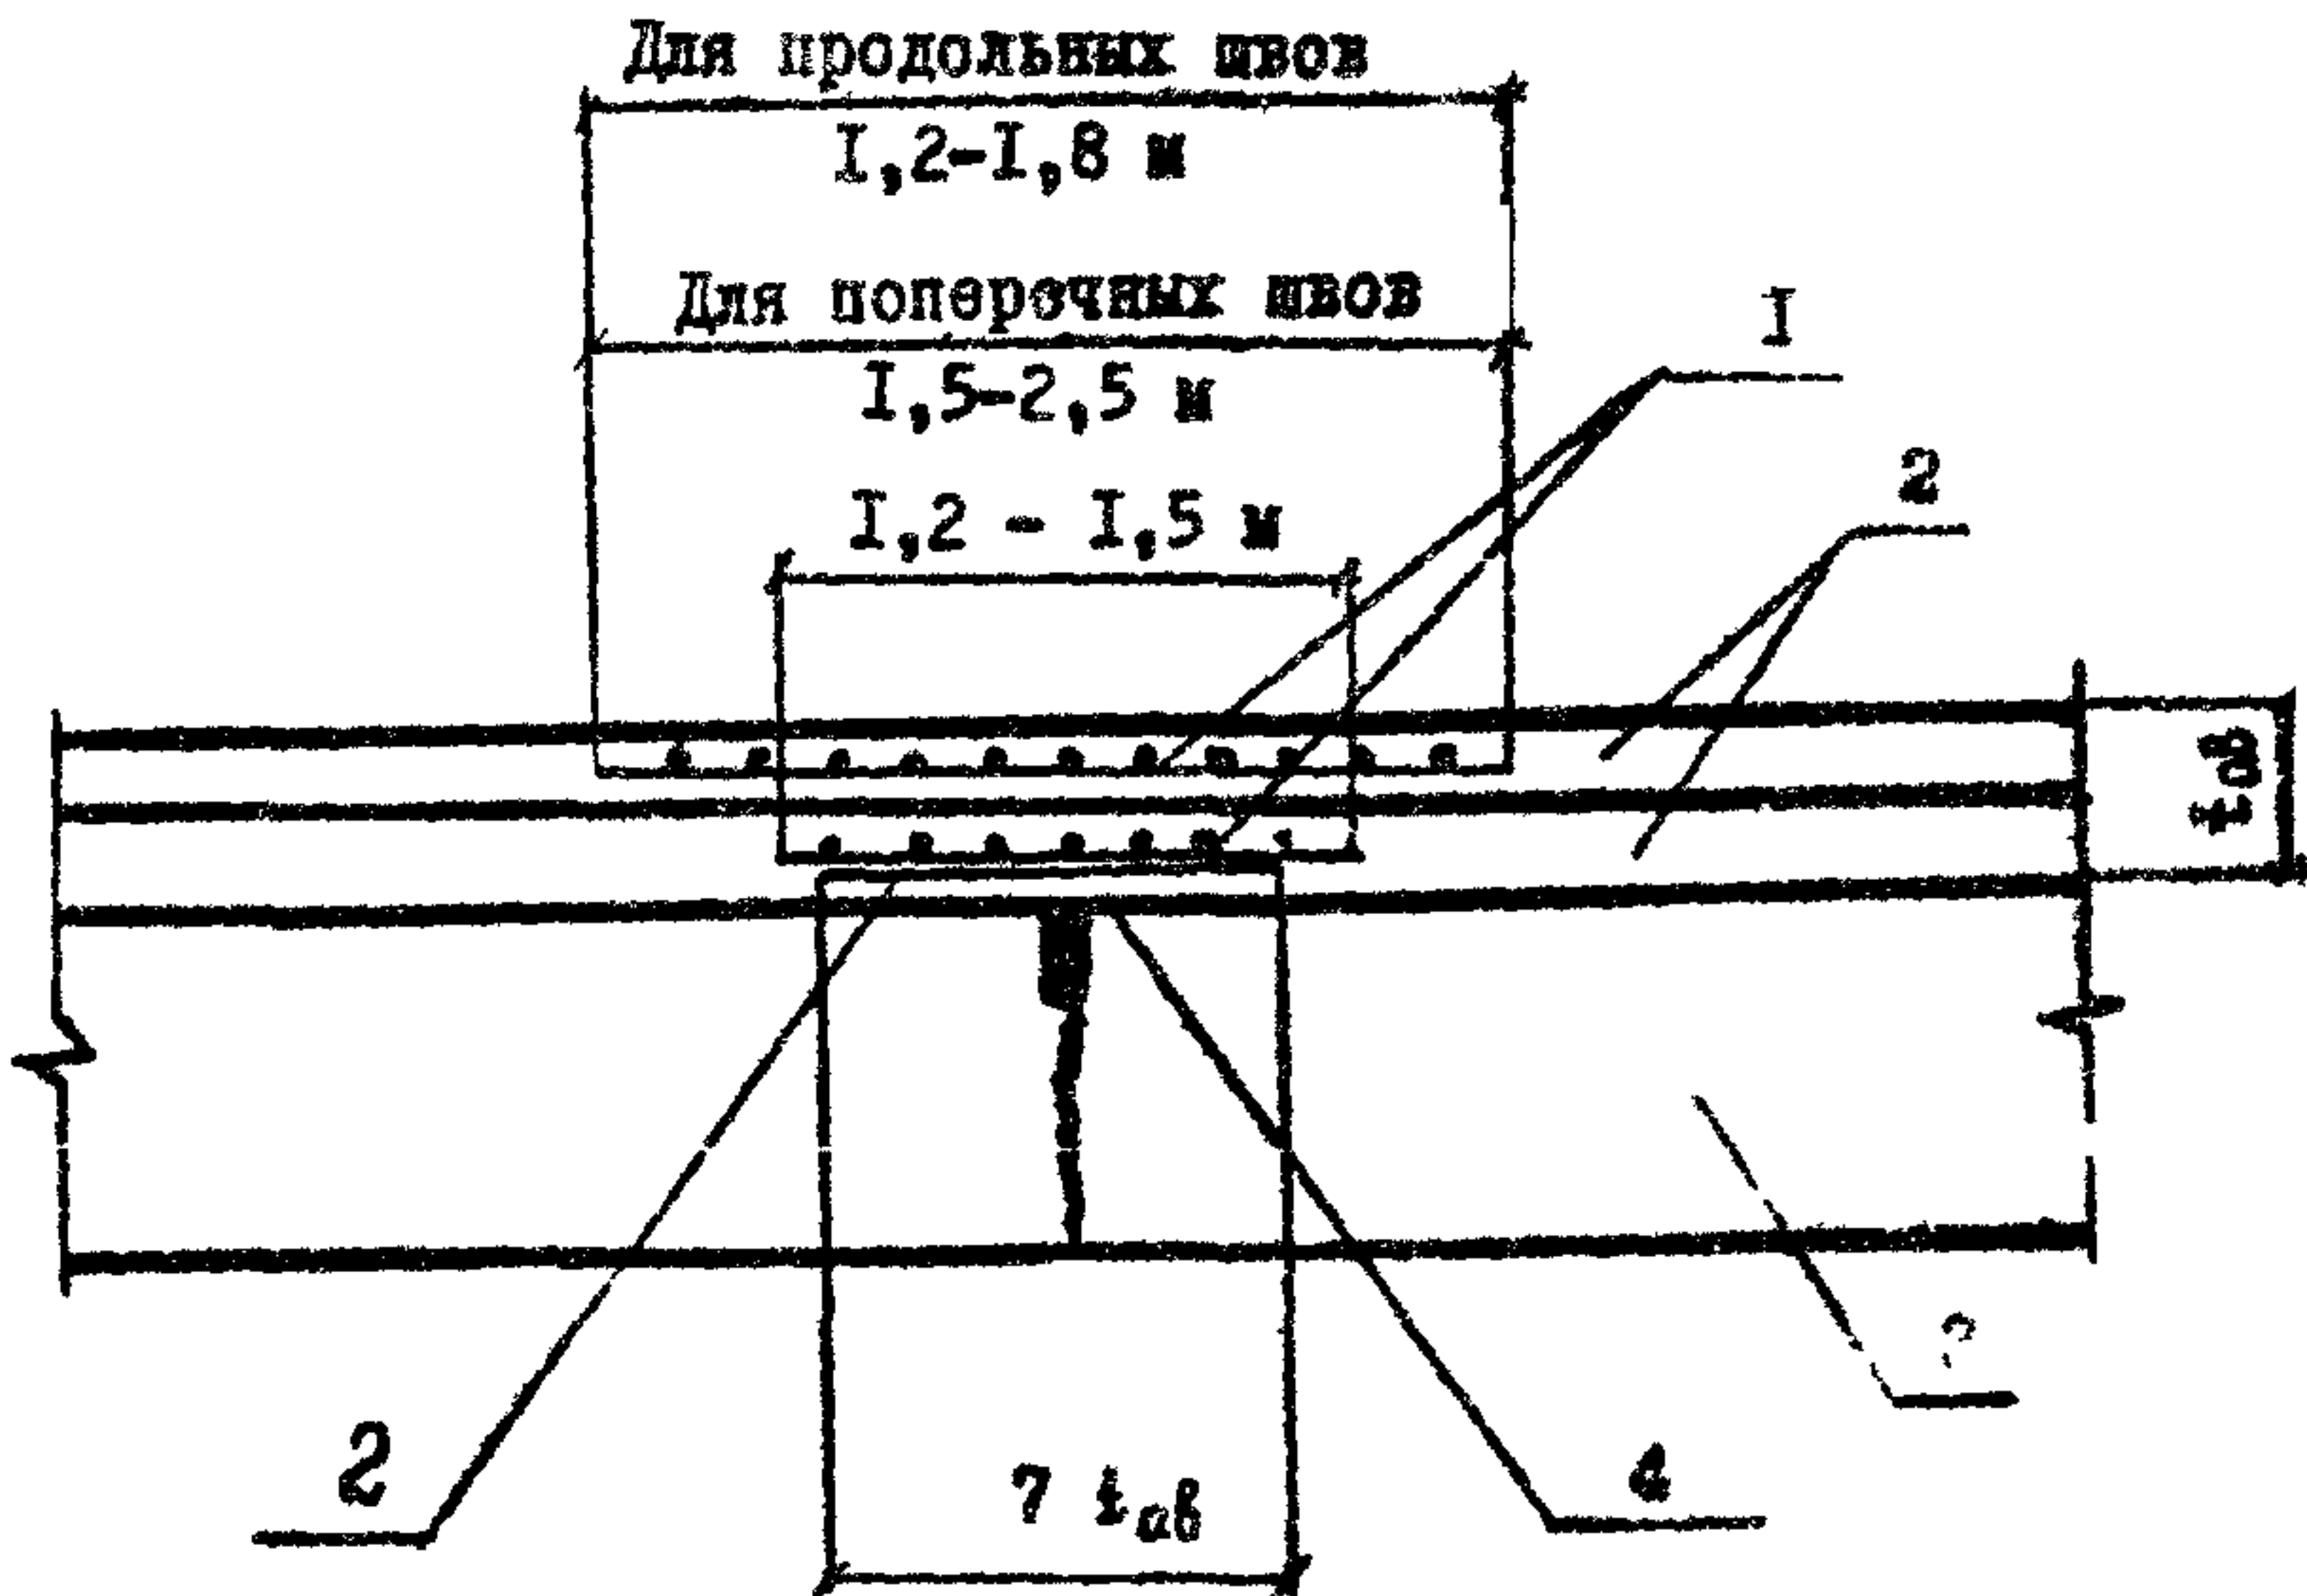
Конструкция армирования двухслойного асфальтобетона: 1 - стеклопластиковые сетки; 2 - верхний и нижний слой асфальтобетона; 3 - существующее жесткое покрытие; 4 - побелка известковым молоком; 5 - пергамин
